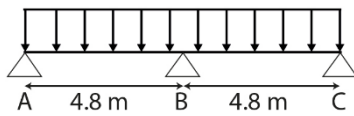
Schéma de disposition des poutrelles du plancher 16+5.
